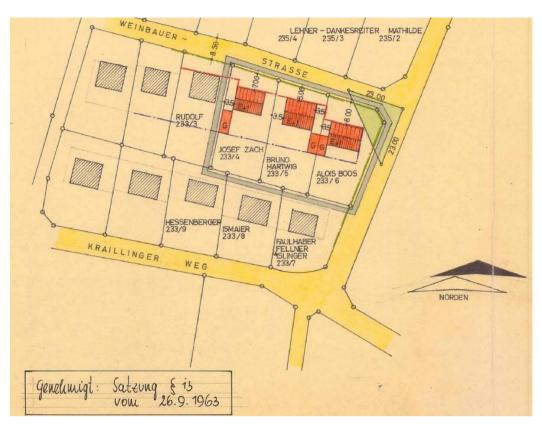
Ausschnitt aus der Änderung des Bebauungsplanes" vom 17.9.1963 (Ü92), ohne Maßstab
